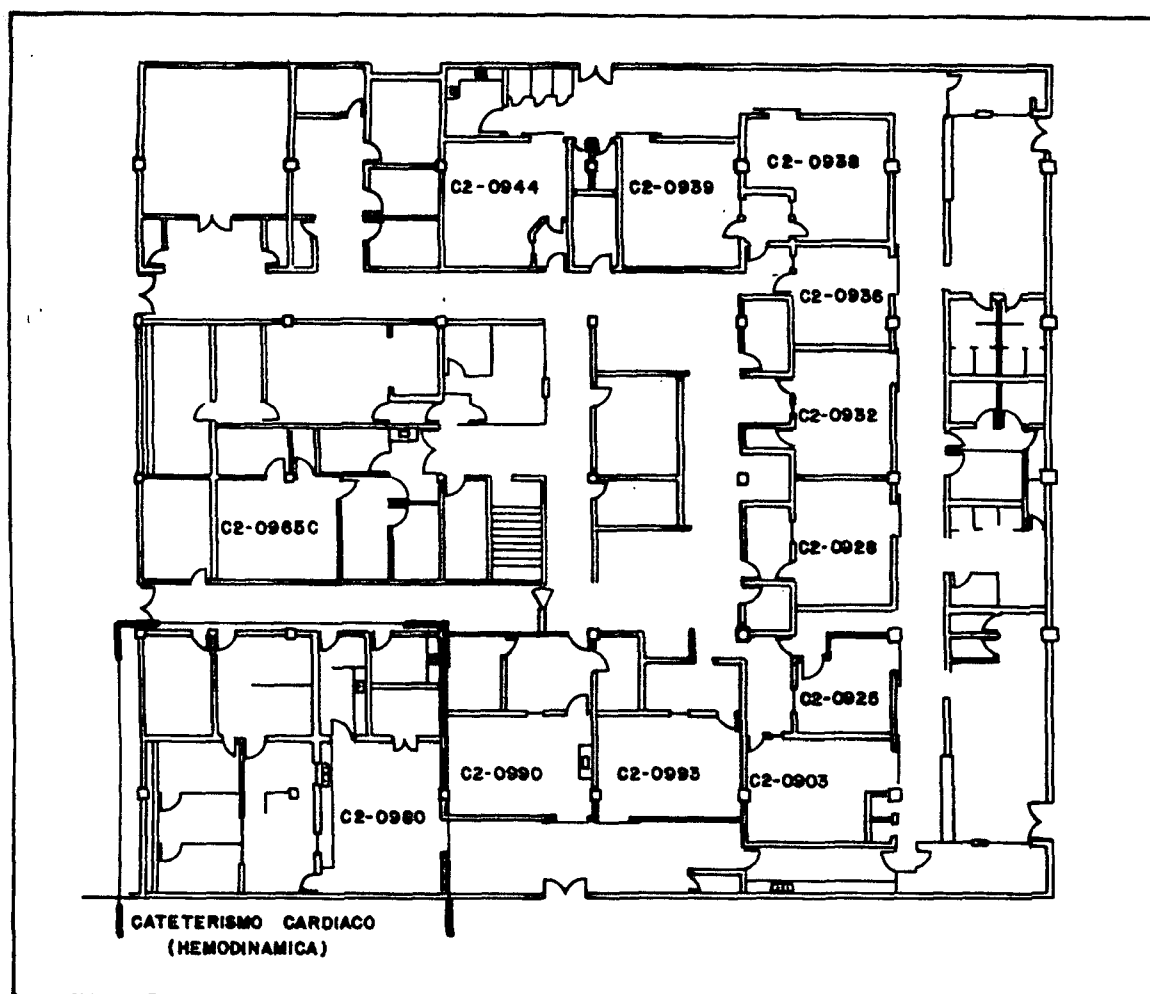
PLANTA BAIXA DO BLOCO C2 DO HC
